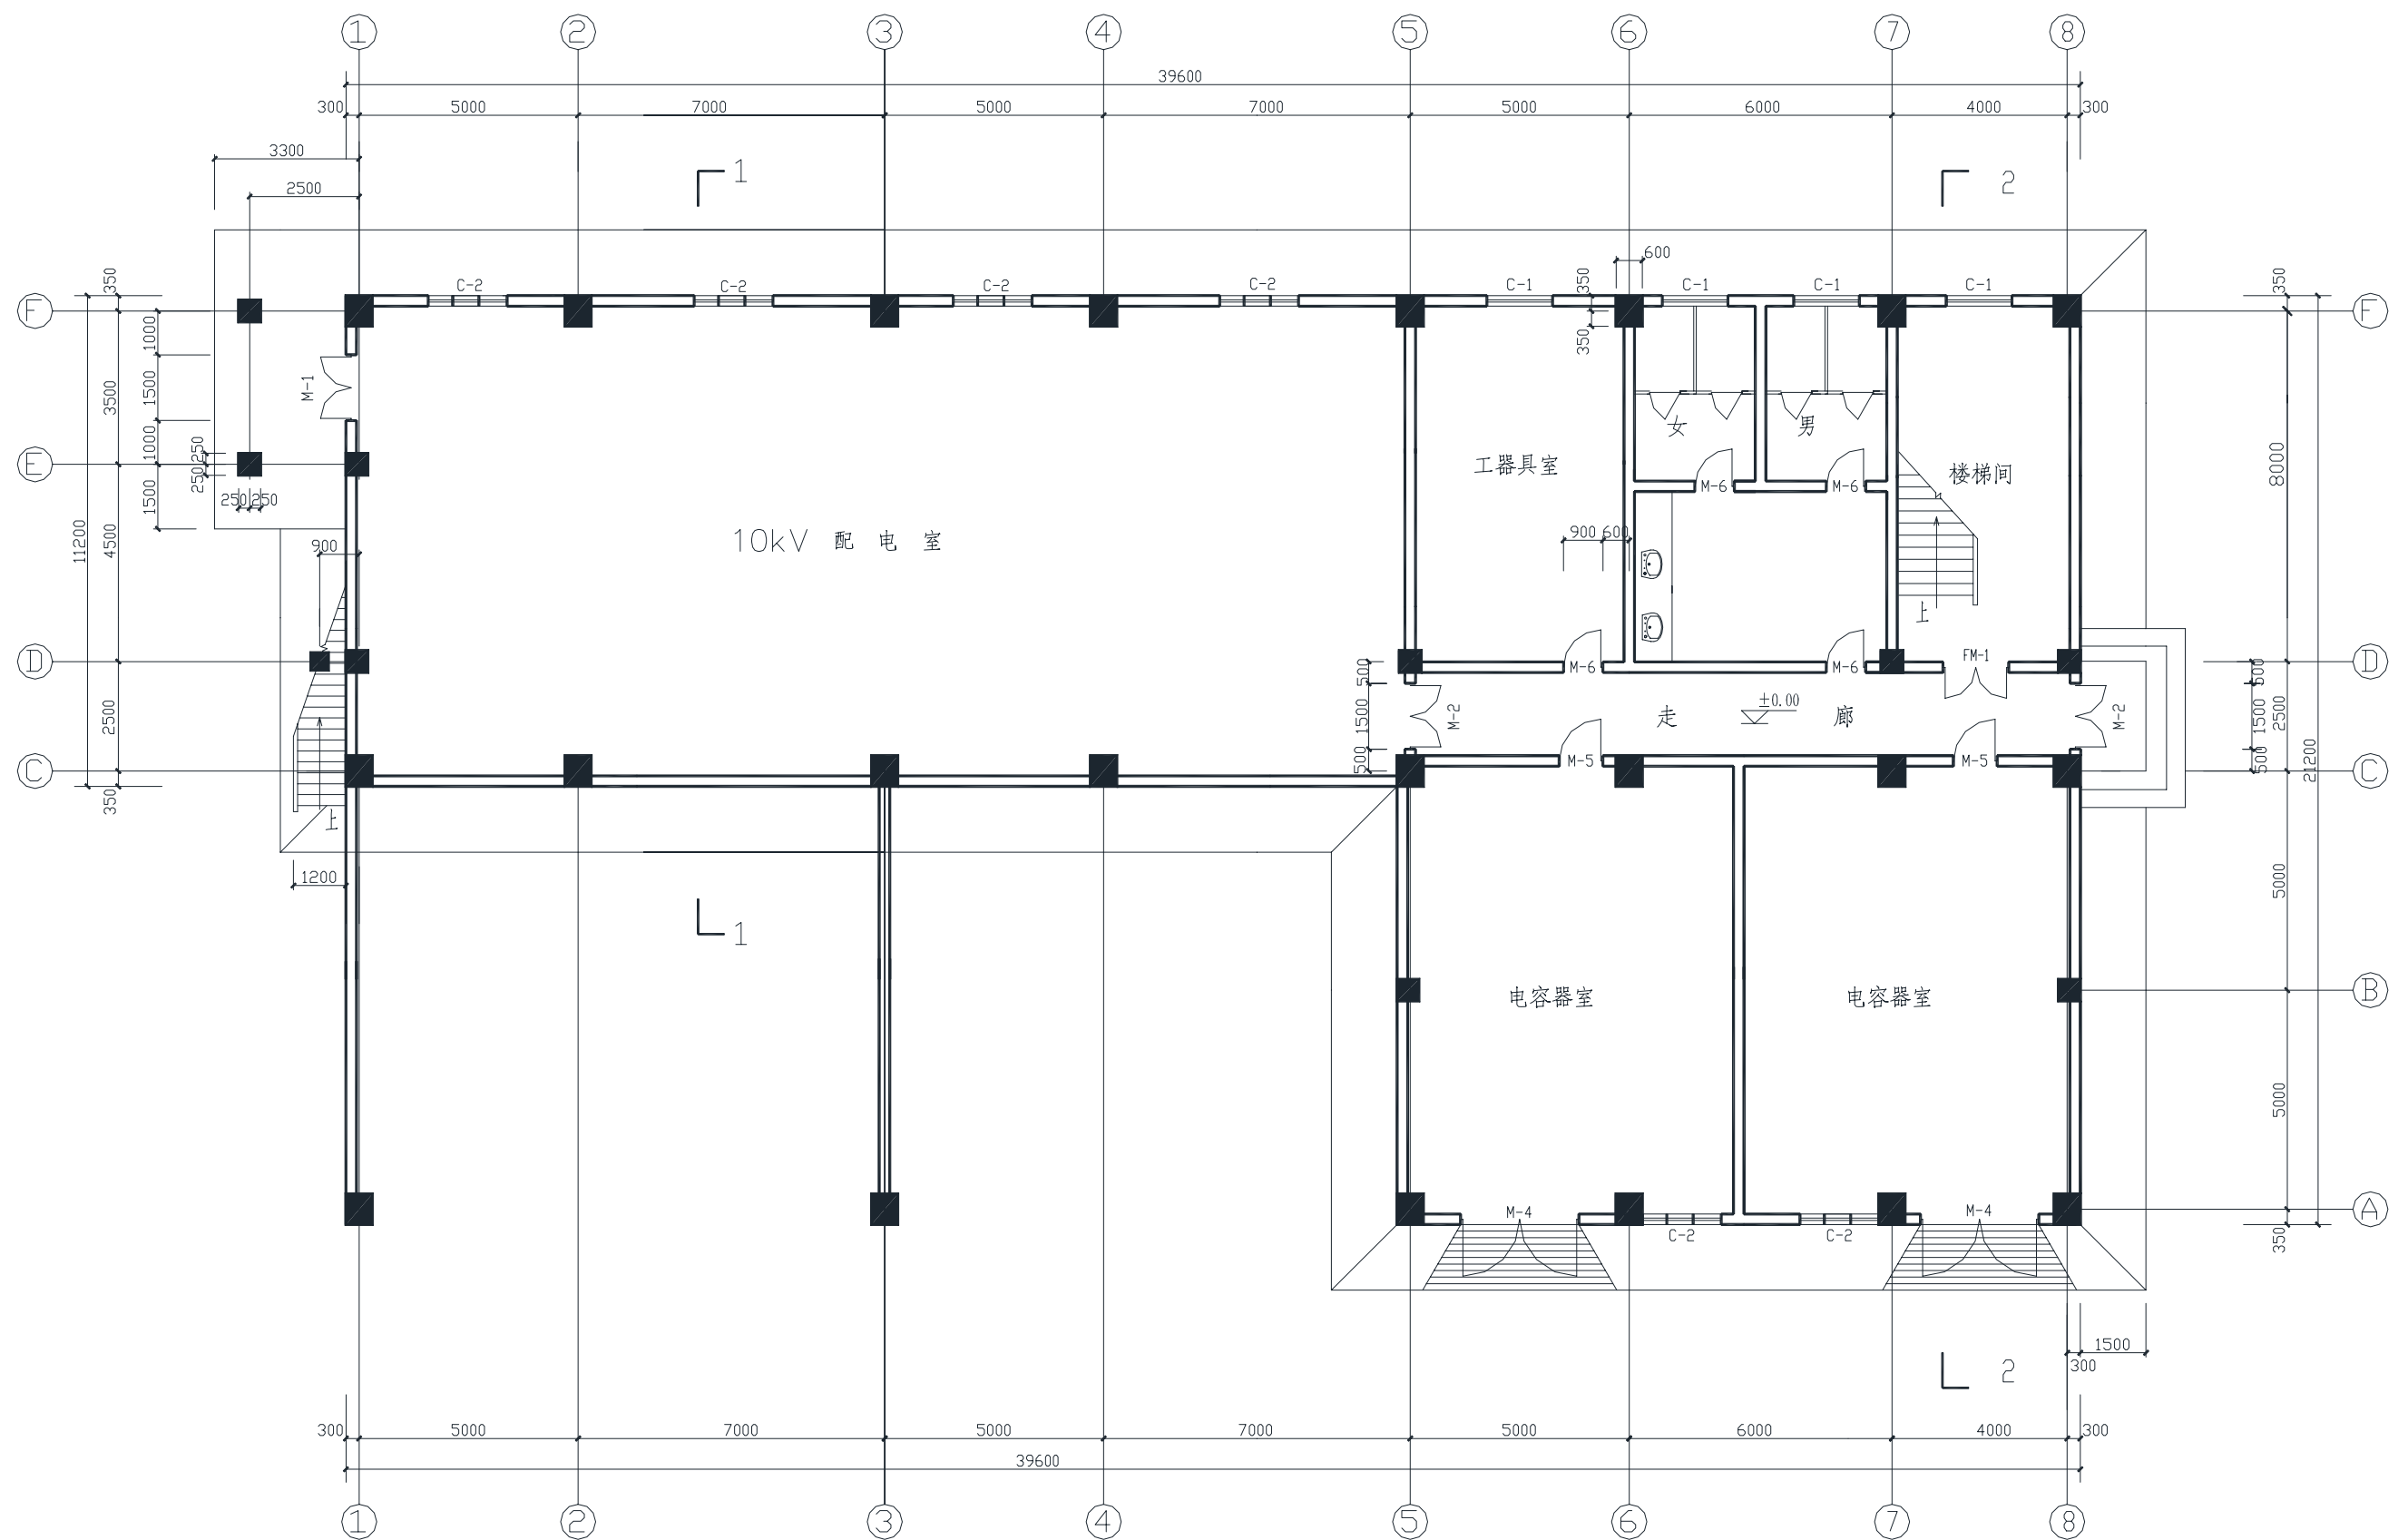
综合配电楼一层平面布置图(A3-2-05)
